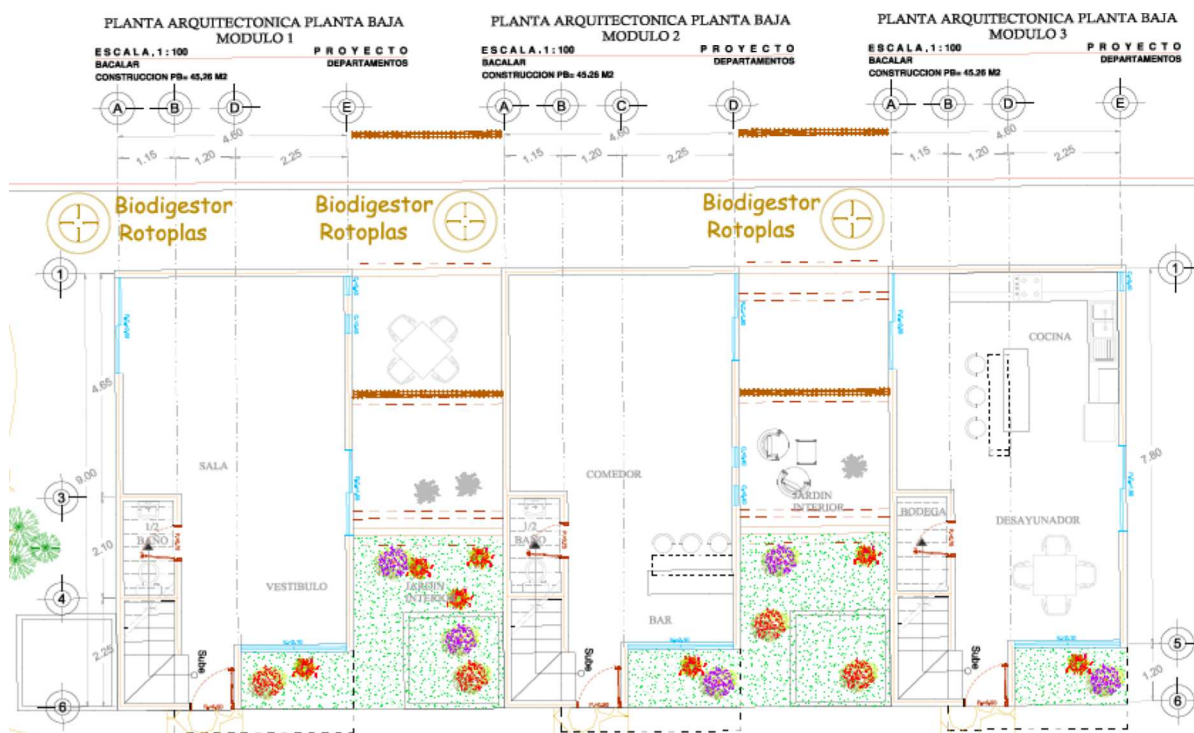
Planos generales de los módulos de planta baja del proyecto “QUINTA SAN CHARBEL” y distribución de las superficies.
